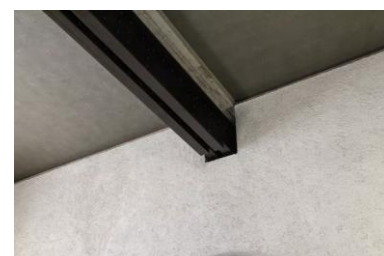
| Detalhe ligação Viga-Parede, Museo di Castelvecchio, Carlo Scarpa
